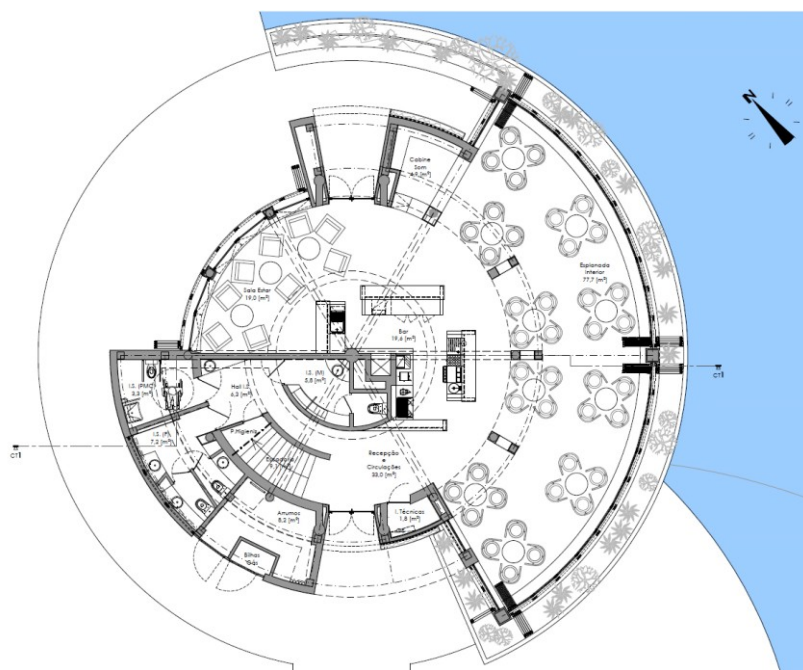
ERB [PROPOSTA], PLANTA PISO 0 [VLÓIO, 2011].
